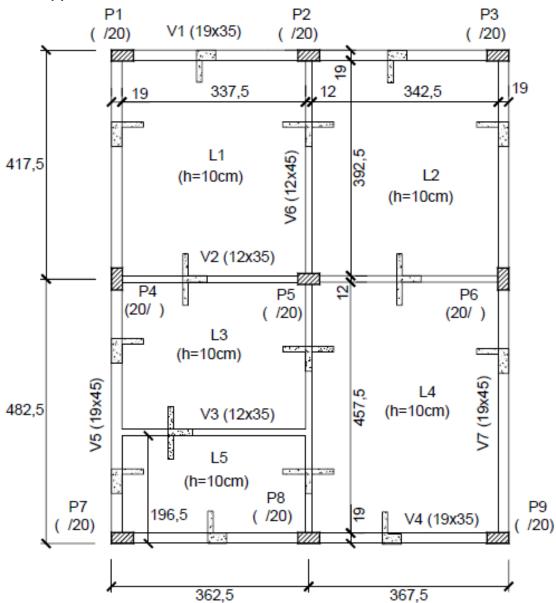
Distribuição dos pilares em um edifício de múltiplos pavimentos.
